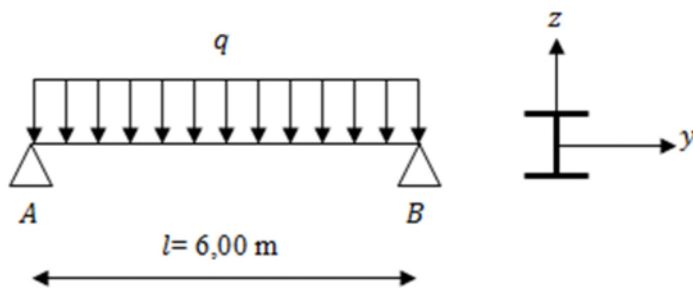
Schéma statique de la poutre la plus sollicitée.
